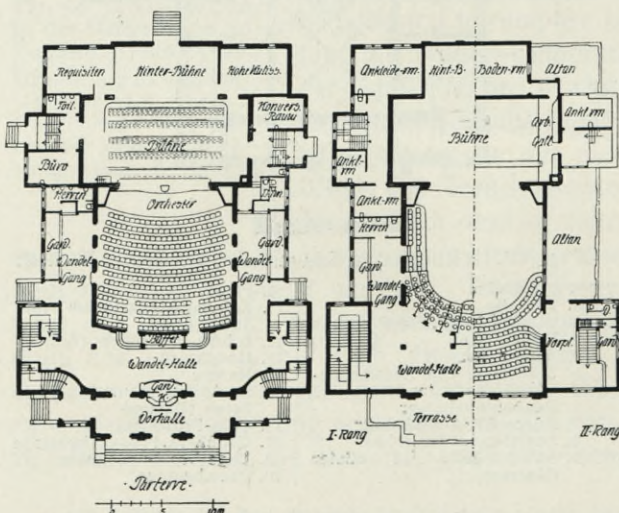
Stadttheater zu Wolfenbüttel. Grundrisse.
